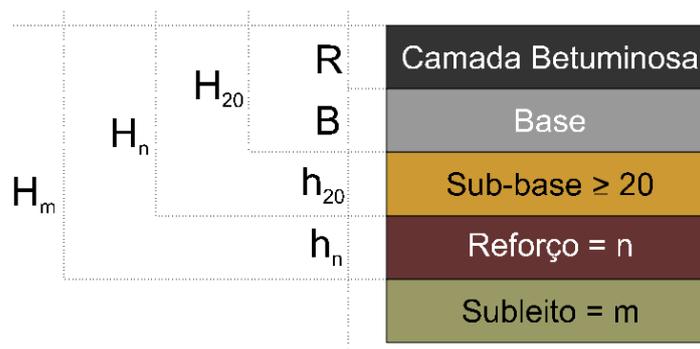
Nomenclaturas designadas para as camadas do pavimento
